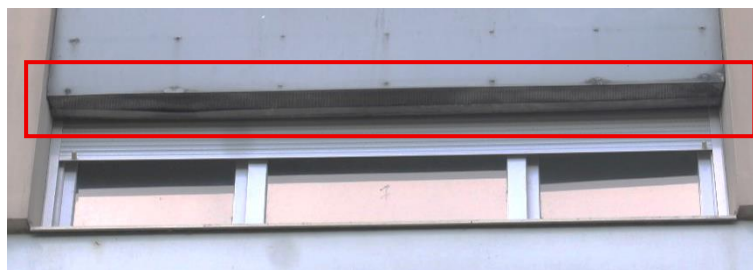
Potentialités d'accueil identifiées sur la façade 8 ainsi que sur la quasi-totalité des autres façades (© ECR Environnement)
